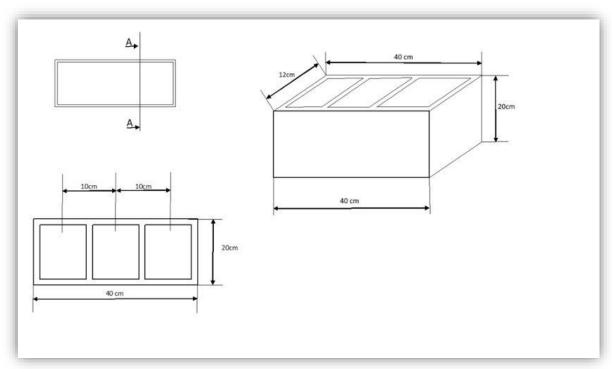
Dimensiones del espécimen bloque de concreto 40x20x12cm
